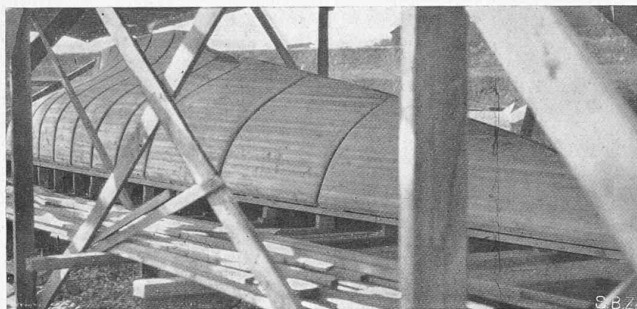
Hölzerne Schalung vor dem Betonieren.
